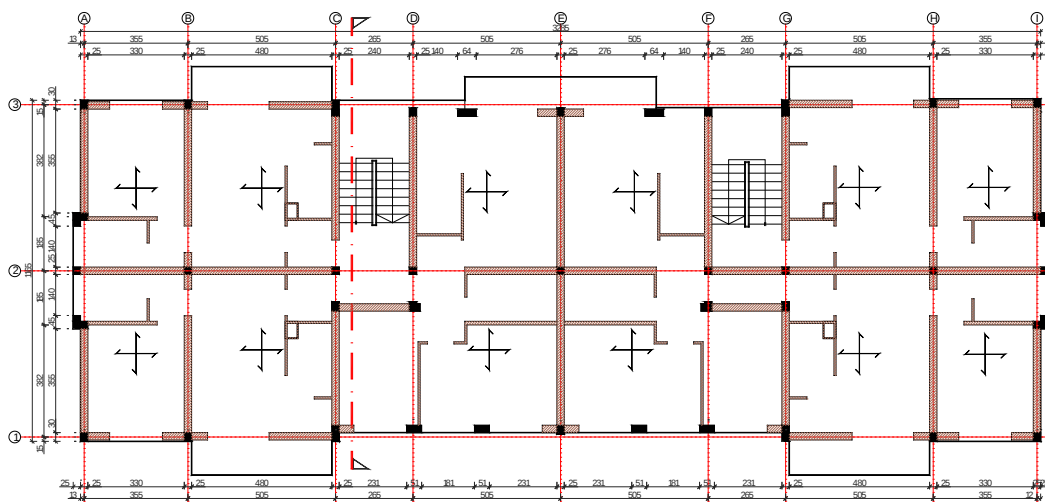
Planimetria e katit karakteristik të ndërtesës S12, RC1H – Ram BA
